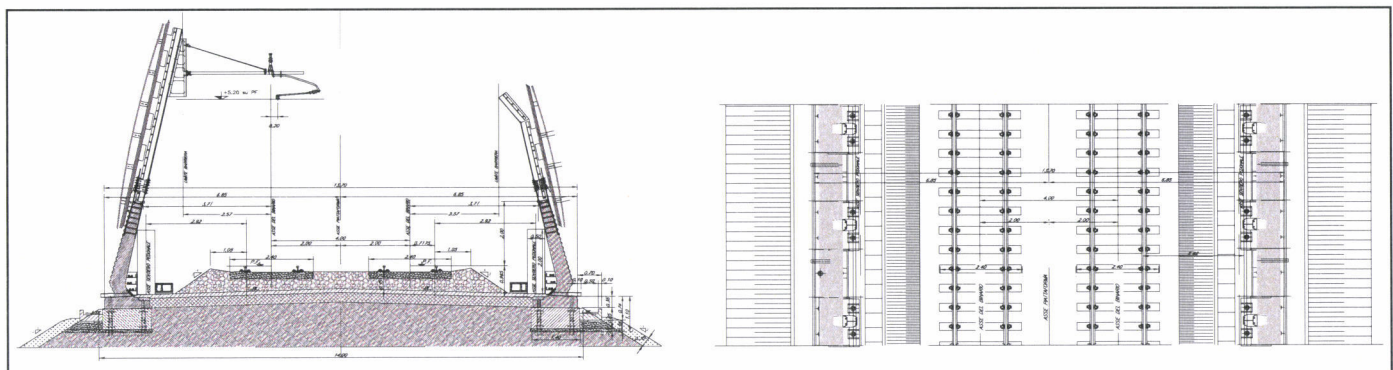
Sezione Tipo doppio binario in Rilevato con Barriere Antirumore
